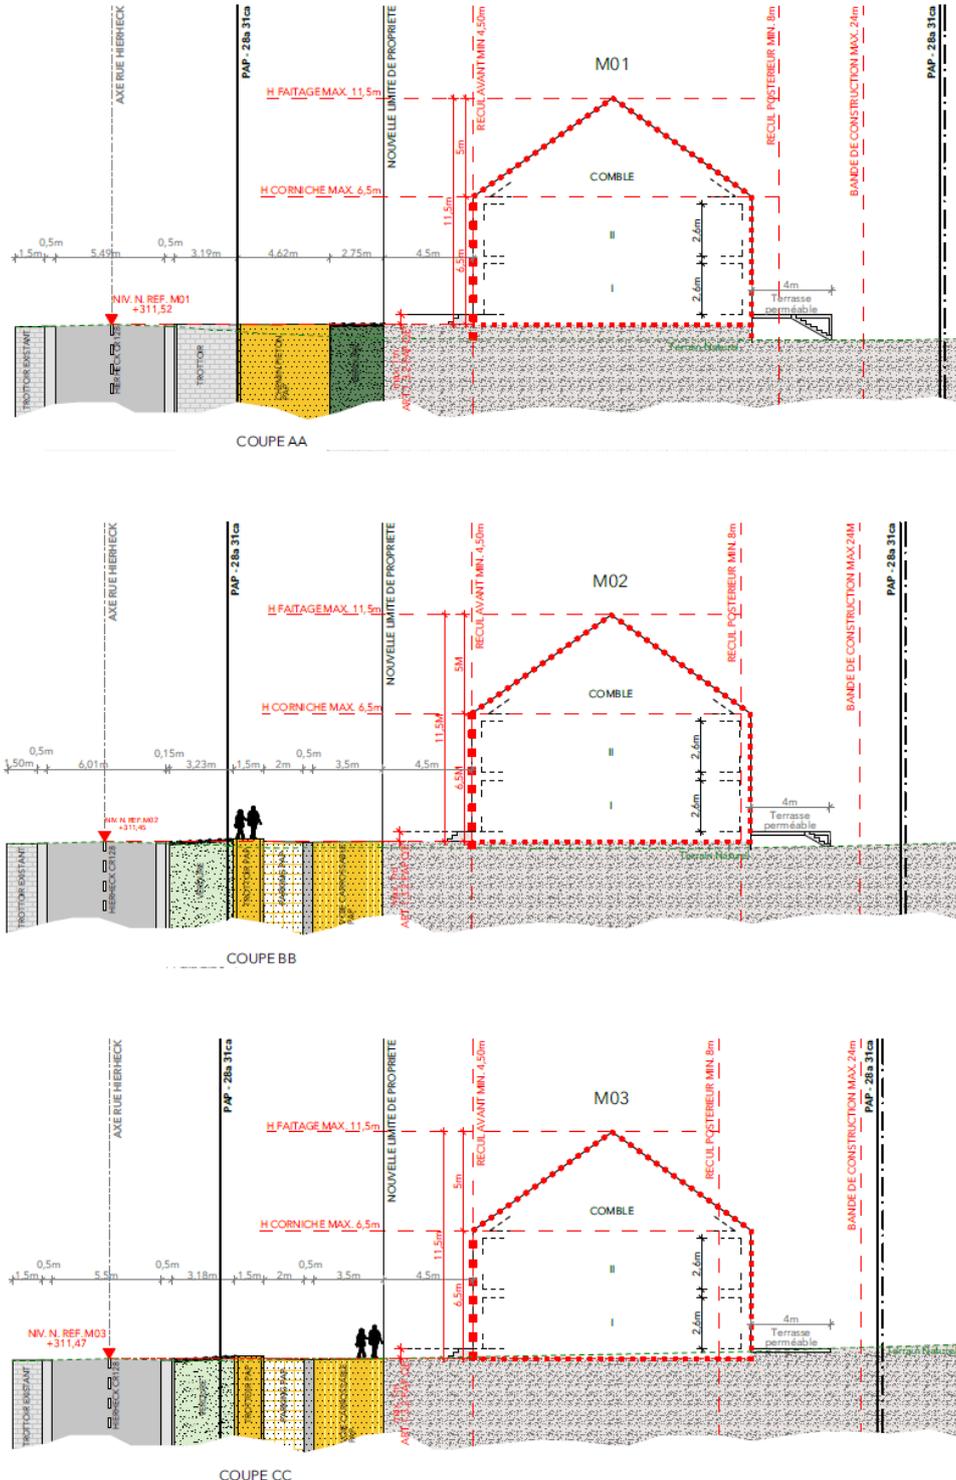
Coupes du projet d'aménagement particulier (source : Acom 04.2023)
